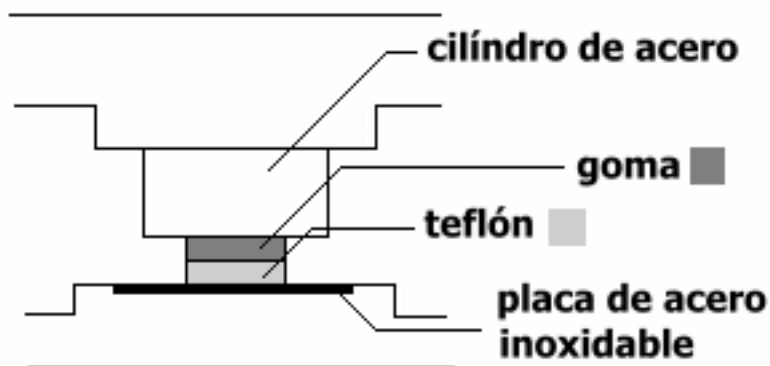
Detalle del apoyo deslizante del sistema TASS.
